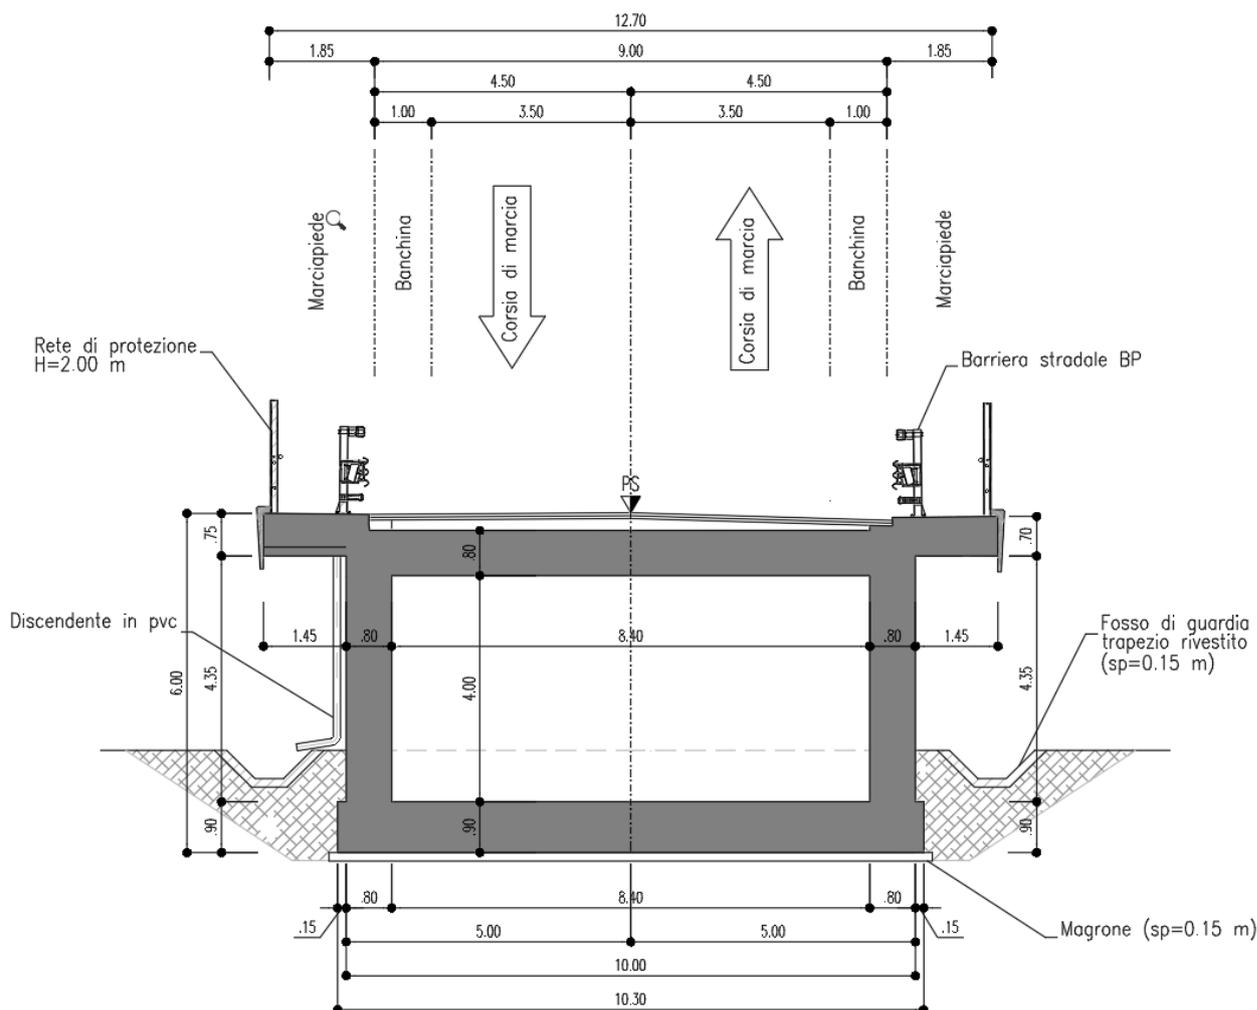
Sezione tipo NV01 su SL01a,VI01 e SL02
